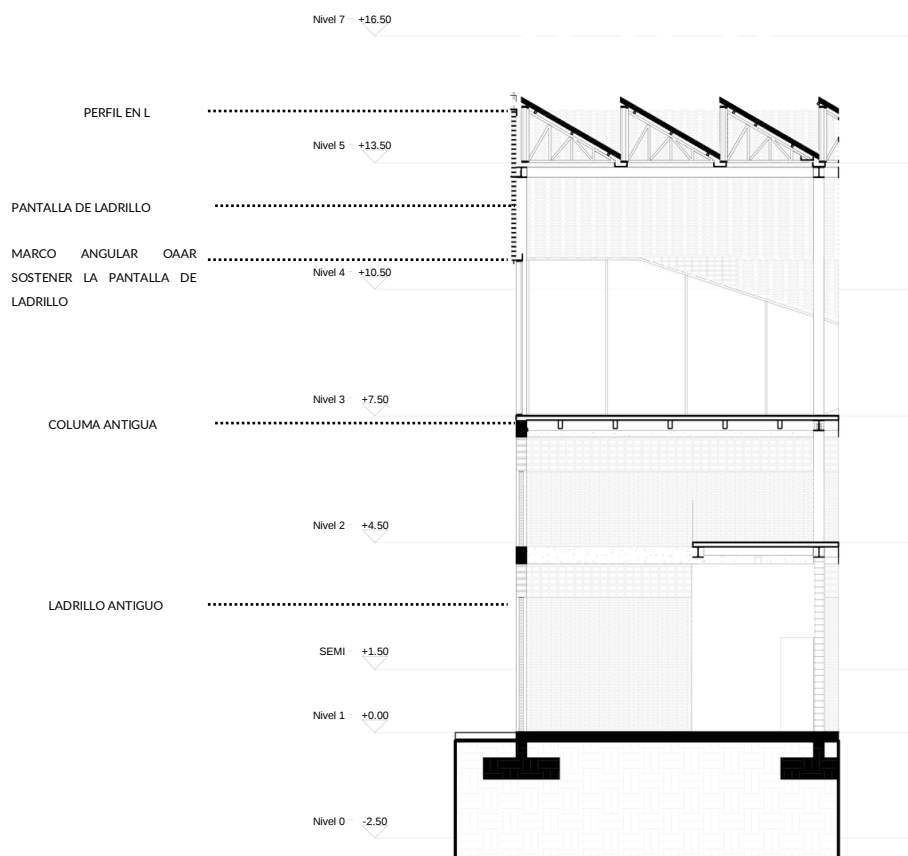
Detalle Corte fachada. Fuente: Propia.
